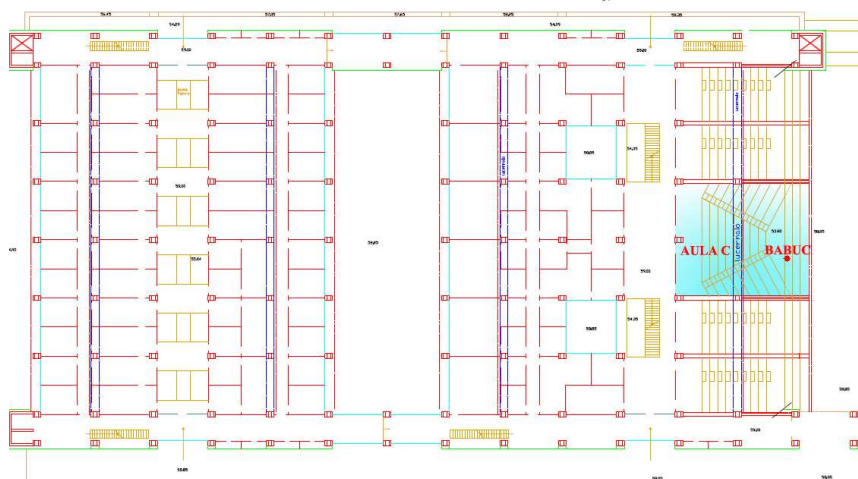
Edificio 17, collocazione in pianta dell'aula Anfiteatro C
